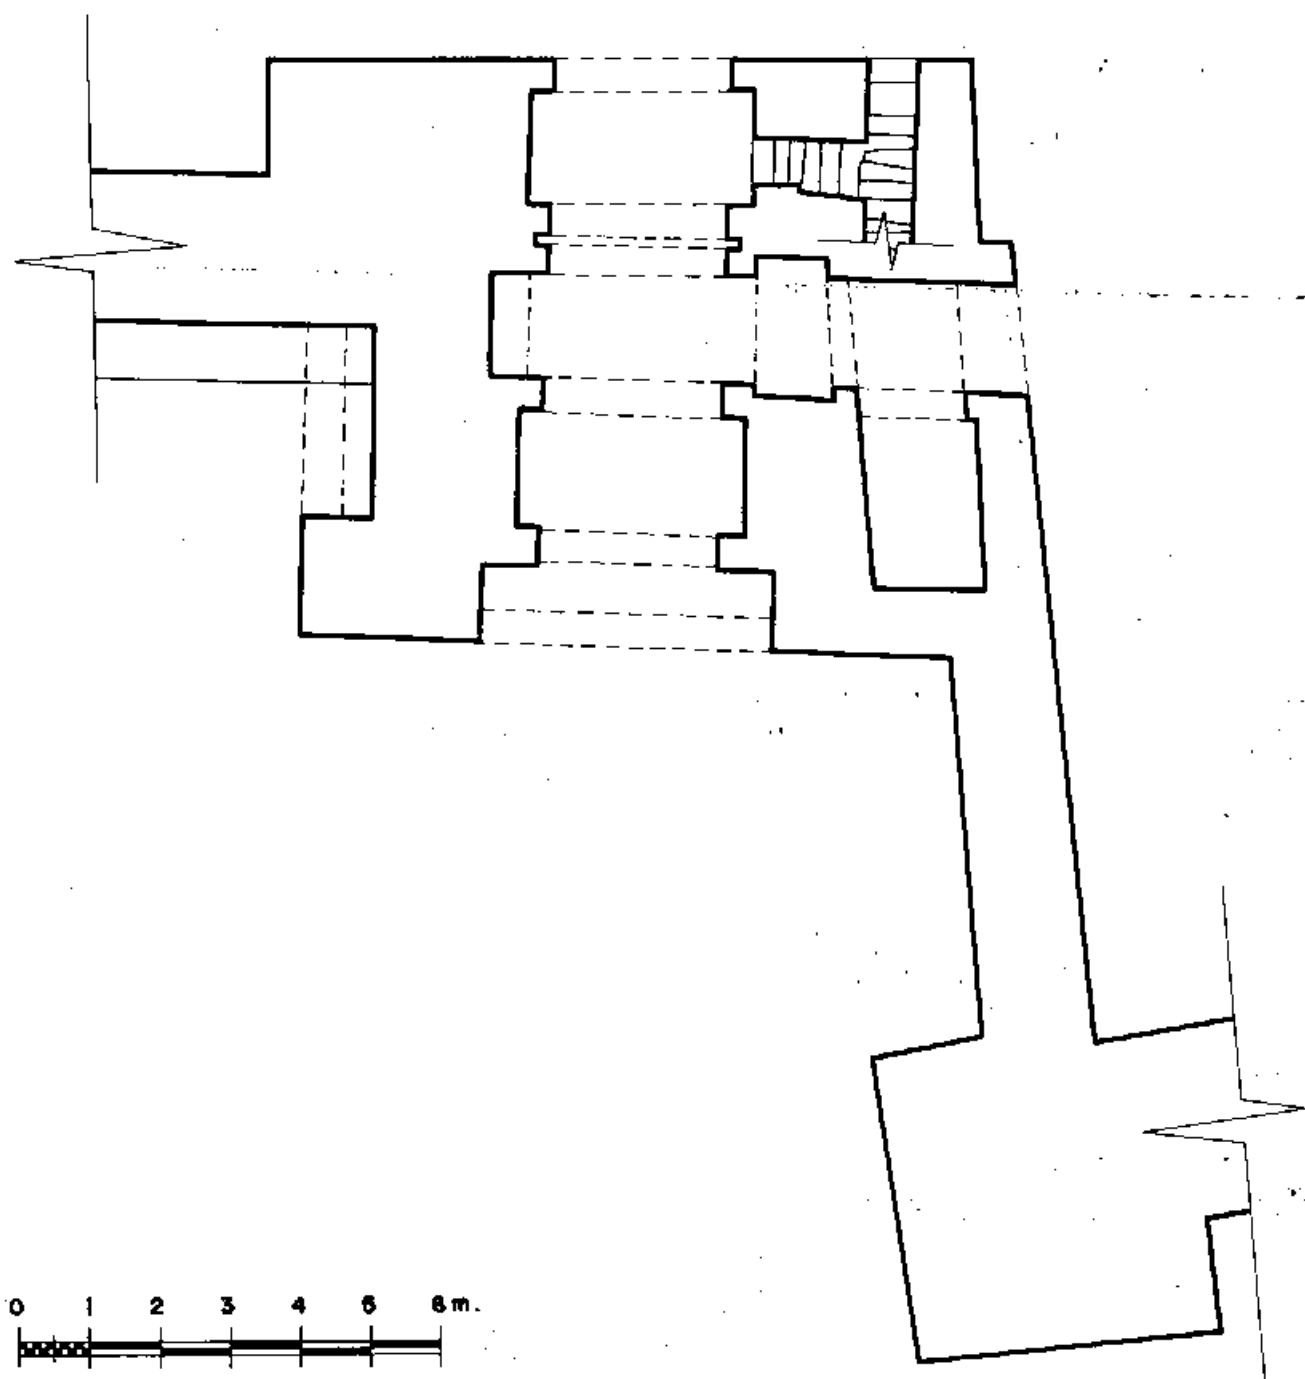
Planta de la puerta. E: 1/100. Dibujo de A. López y L. López.
